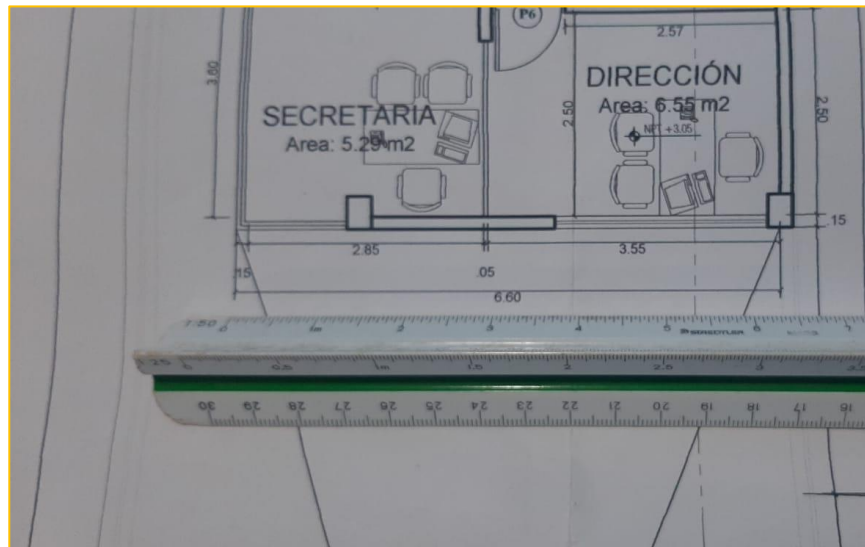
Plano de arquitectura, inconsistencia entre la medida del escalímetro con la medida de cota del plano.
